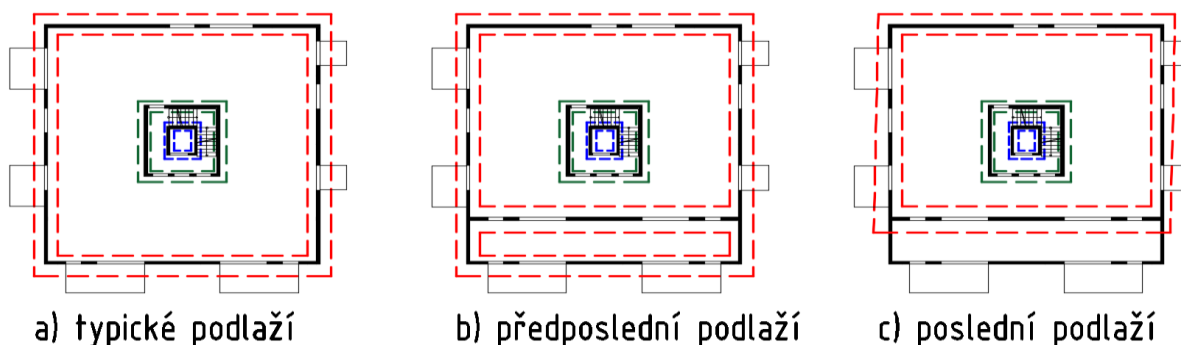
Zobrazení směru postupu realizace realizačních částí
